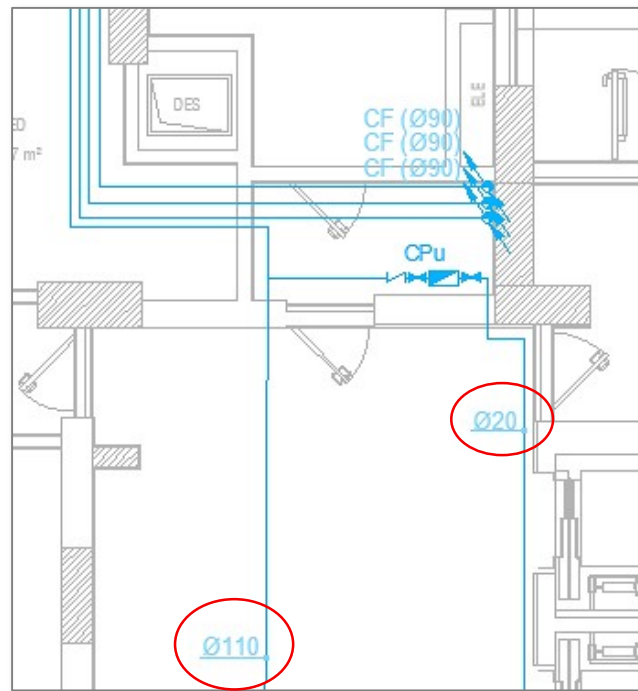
Traçado em 2D das tubagens adjacentes ao contador geral no piso -1 (Fonte: Projeto Hidráulico fornecido)
